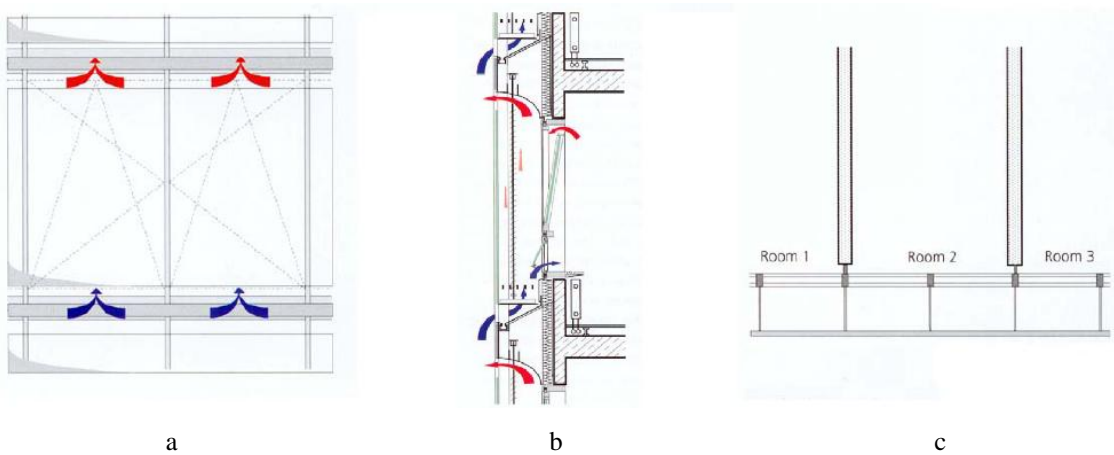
Configuração Modular: Vista frontal - a); Secção transversal – b); Vista em planta – c)
